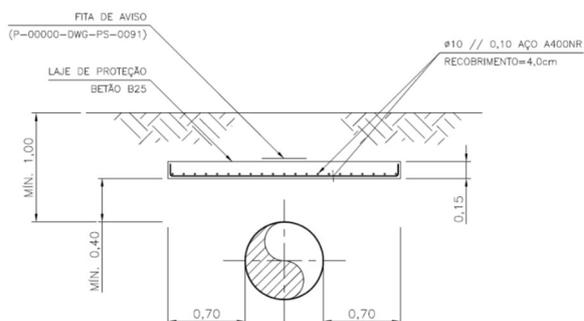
Laje de proteção do gasoduto definida pela REN, S.G.P.S.
